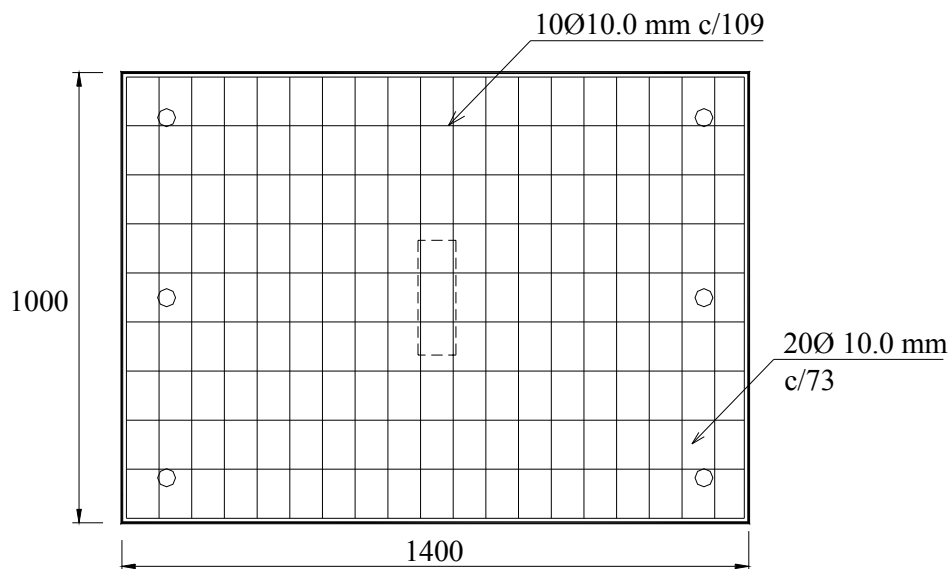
Armadura das lajes L1b, L3b e L5b de Vilhena *et al.* (2006)
